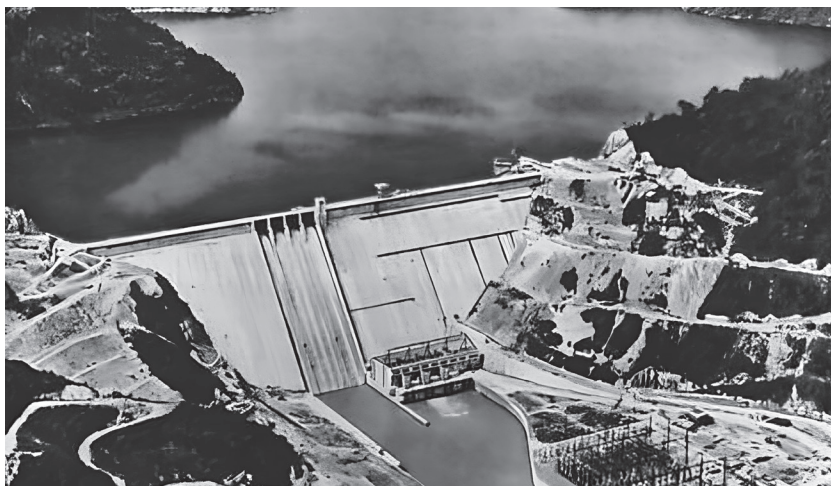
Vista frontal de un sistema hidráulico fluvial que incluye presa ciega de hormigón, presa vertedero y central hidroeléctrica a pie de presa.
